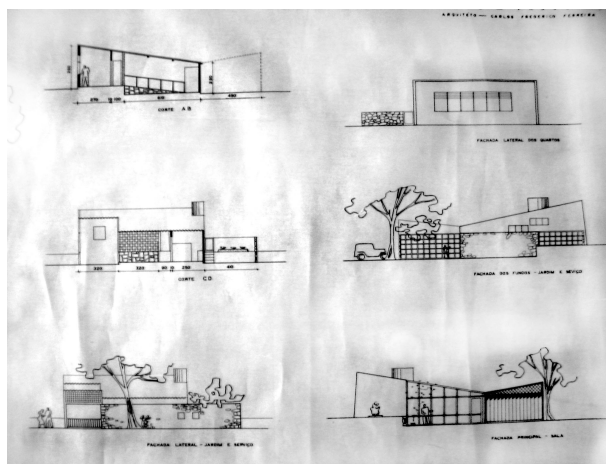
Prancha de Fachadas. Fonte: Arquivo INSS.
